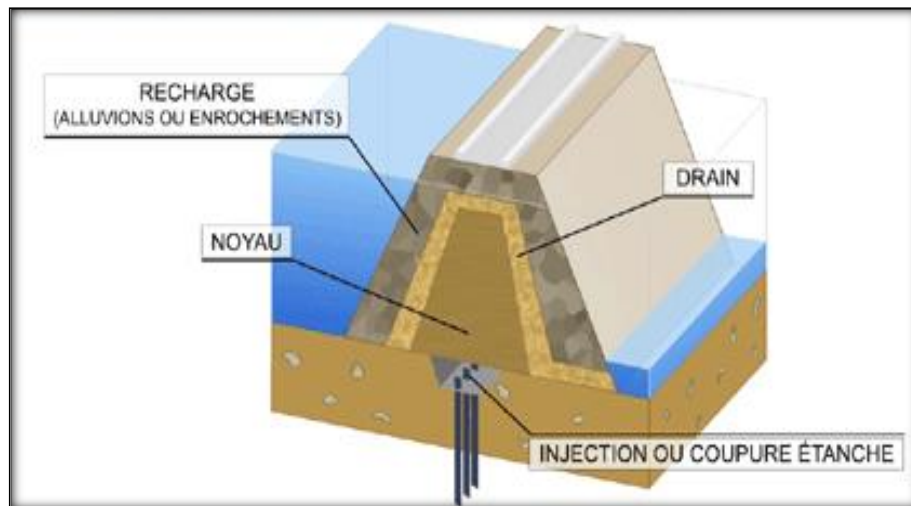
Barrage à noyau (Procèdes généraux de construction des barrages)
